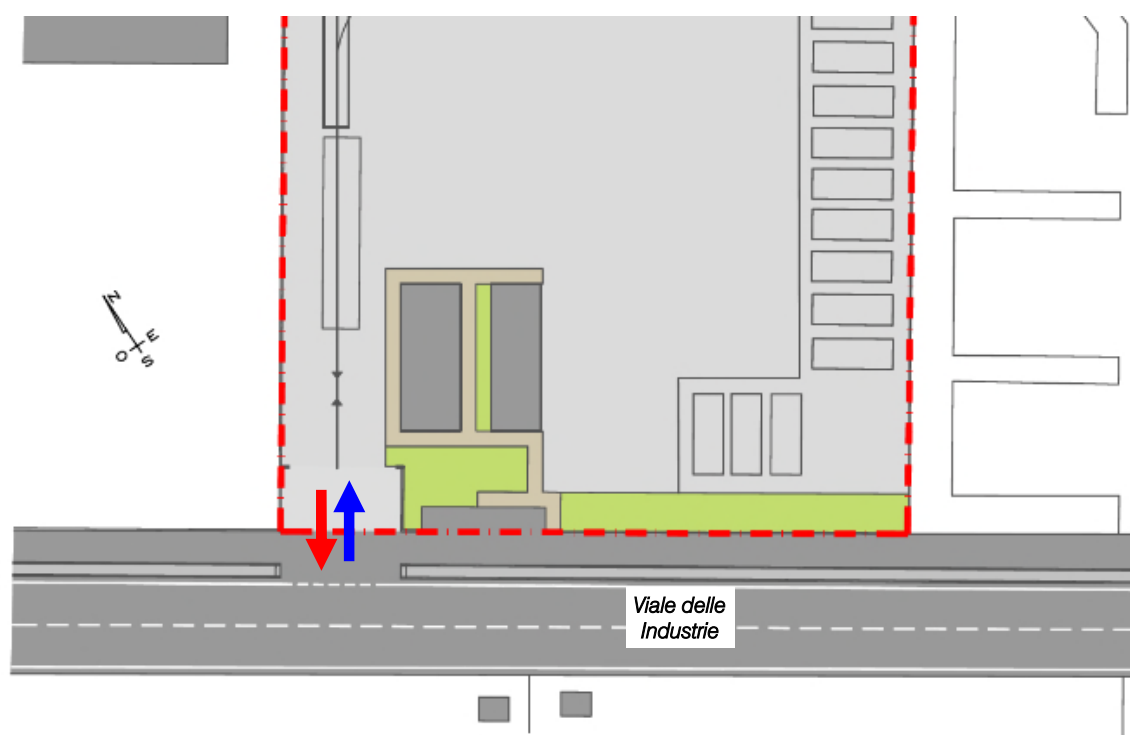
Planimetrie stato attuale e stato di progetto
